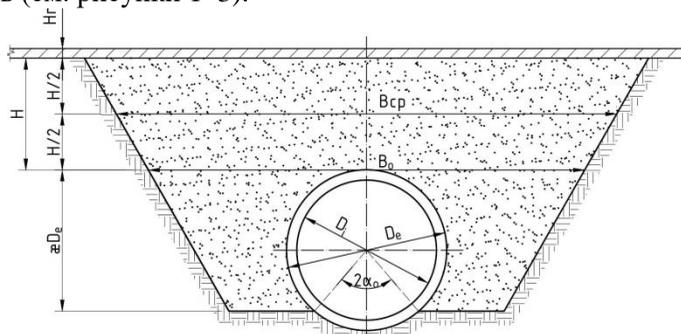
Укладка труб в траншею на грунтовое профилированное основание
